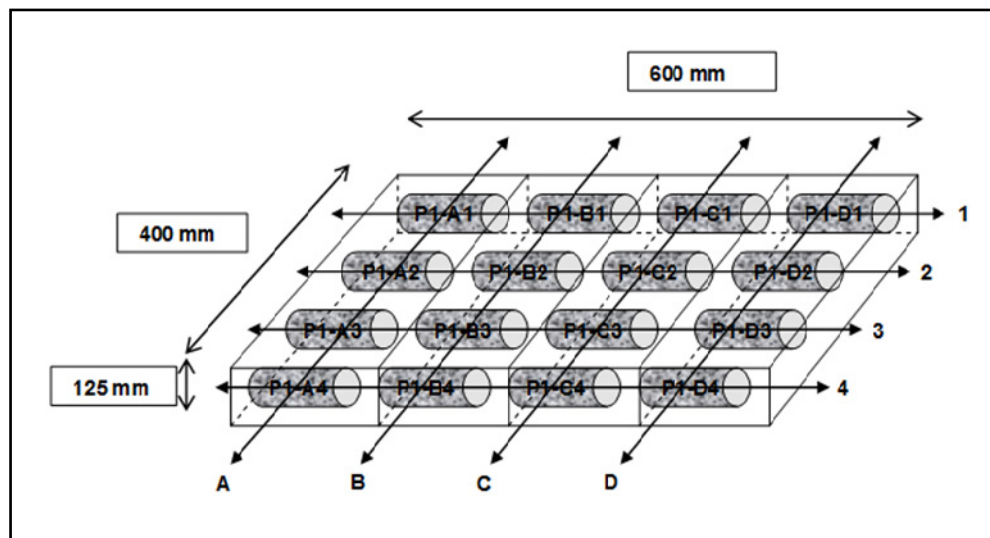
Plan de sciage (A, B, C et D) et de carottage (1, 2,3 et 4)
